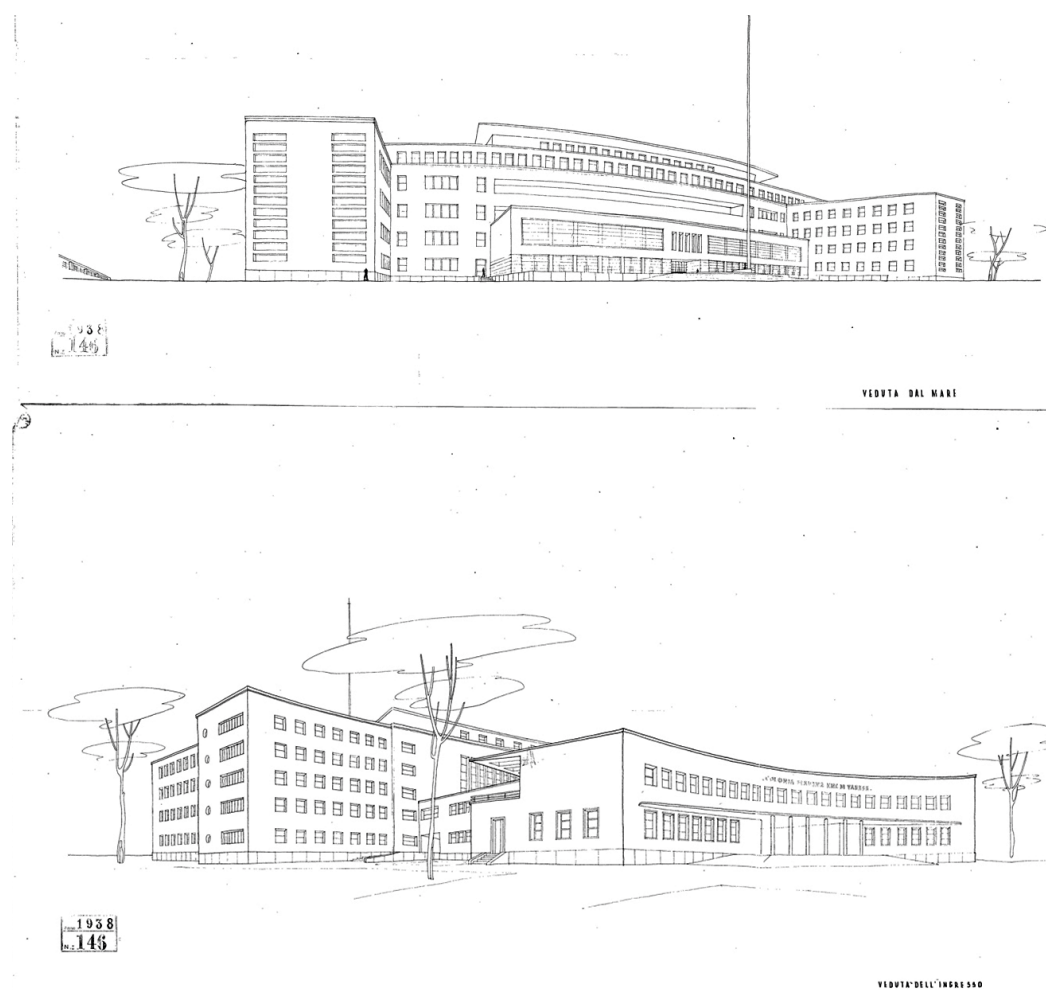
Disegni di progetto della Colonia Varese. In alto vista dal mare, in basso vista dall'ingresso (Archivio di Stato di Ravenna).
